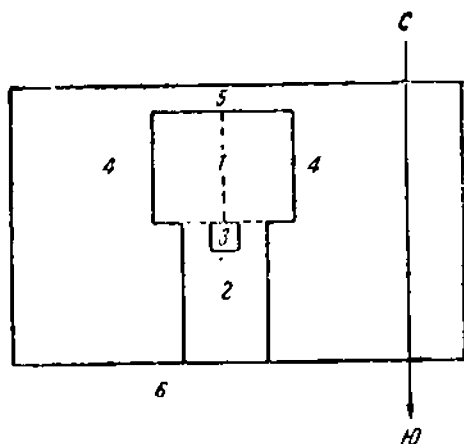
Разбивка площадки под пару биотермических камер емкостью по 2 м^3 каждая:
